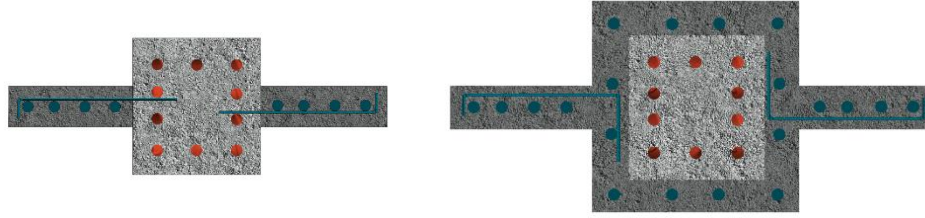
Conexión de los segmentos de muro con la columna existente: a) anclaje del refuerzo horizontal en la columna; b) anclaje del refuerzo horizontal del muro en el encamisado de la columna. Fuente: INIFED (2021d) con base en Terán (2009)
